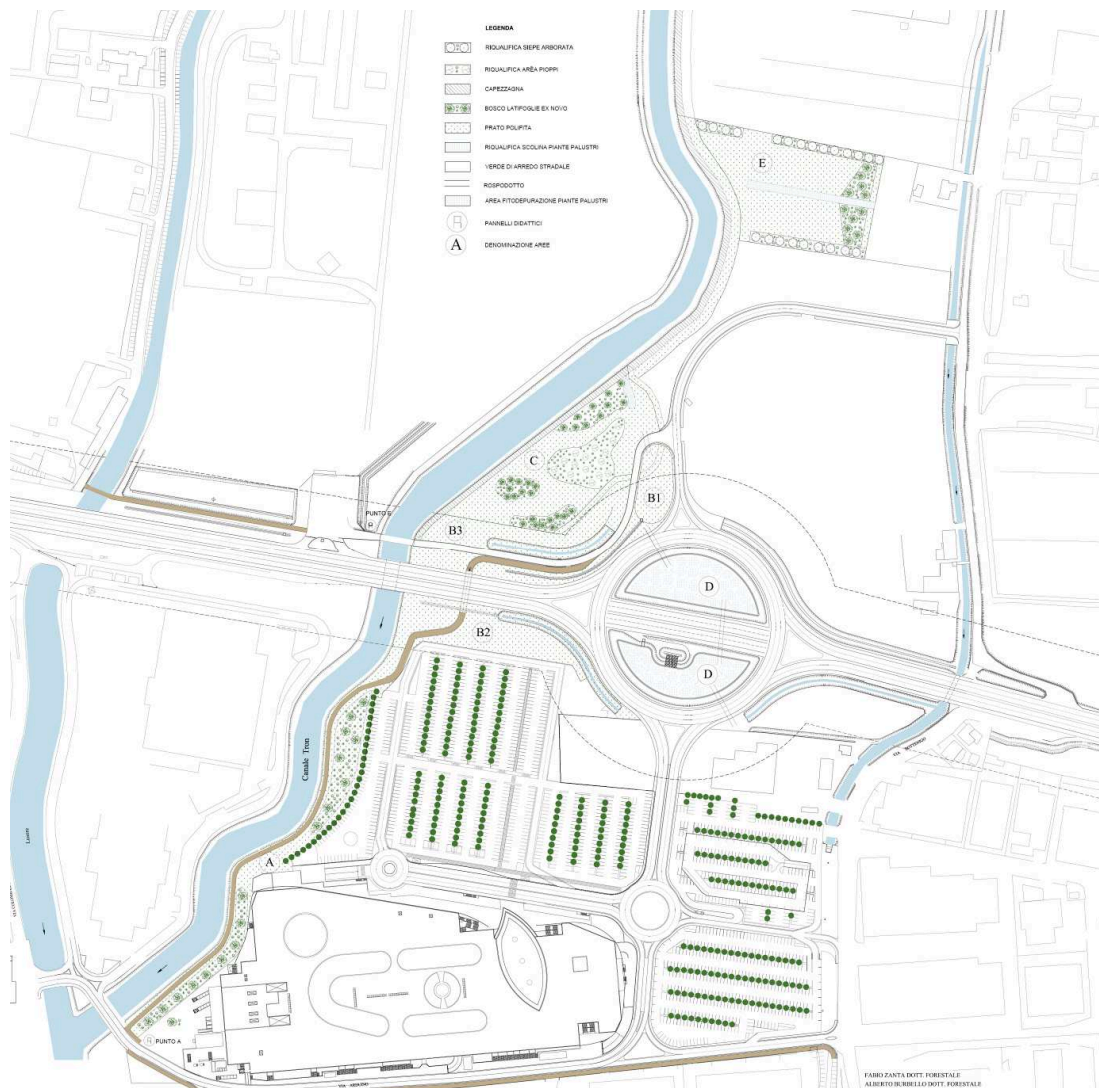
Planimetria dell'area con i ripristini attuati dopo la costruzione del Complesso Nave de Vero
